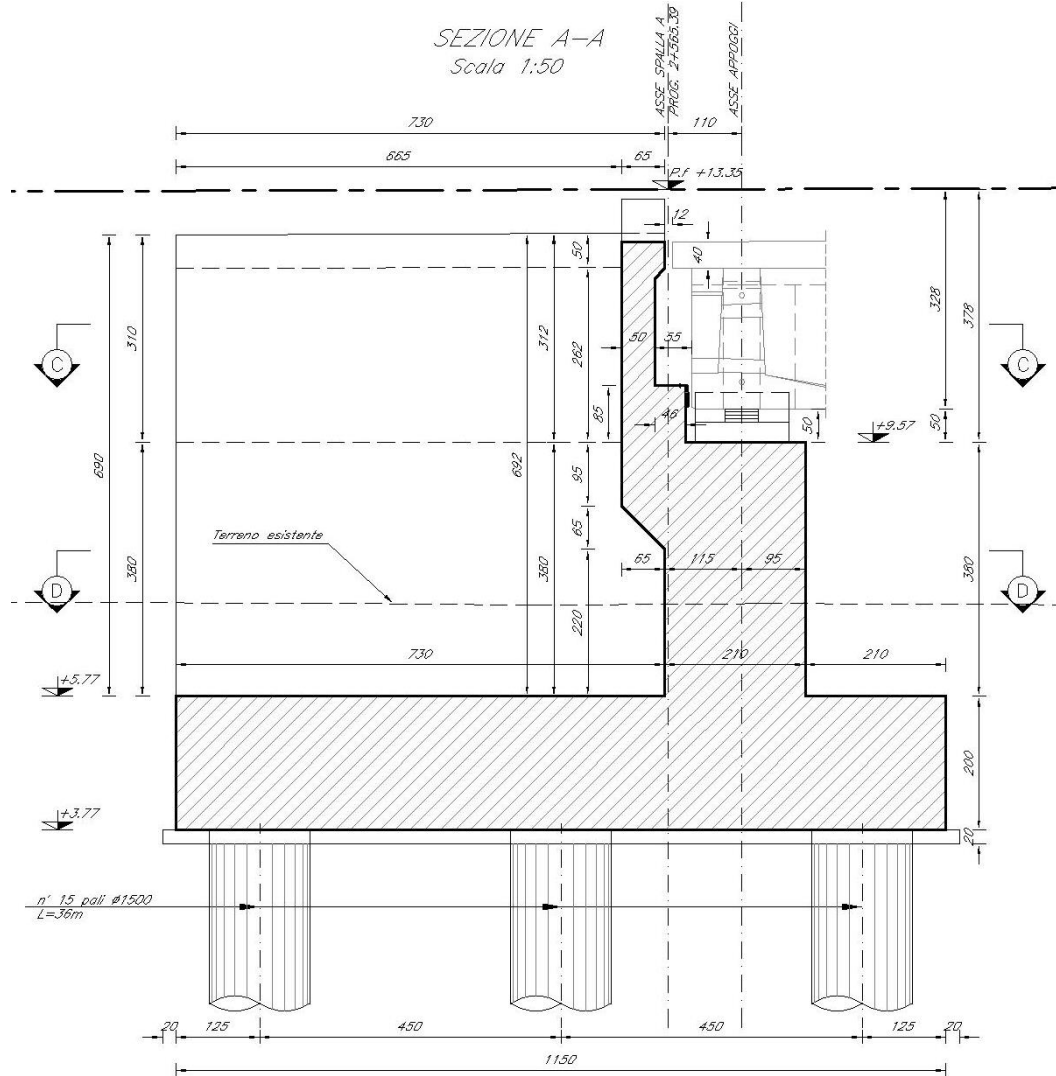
Sezione longitudinale spalla SPA
